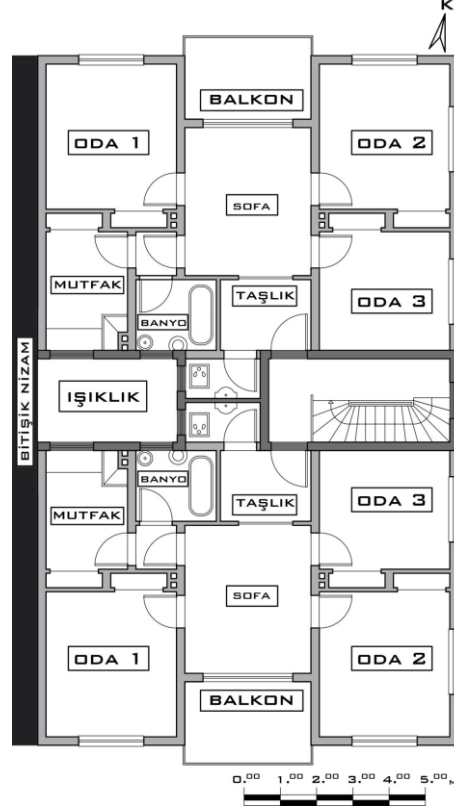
Erciyes Apartmanı Planı (Aydın, 2017)
